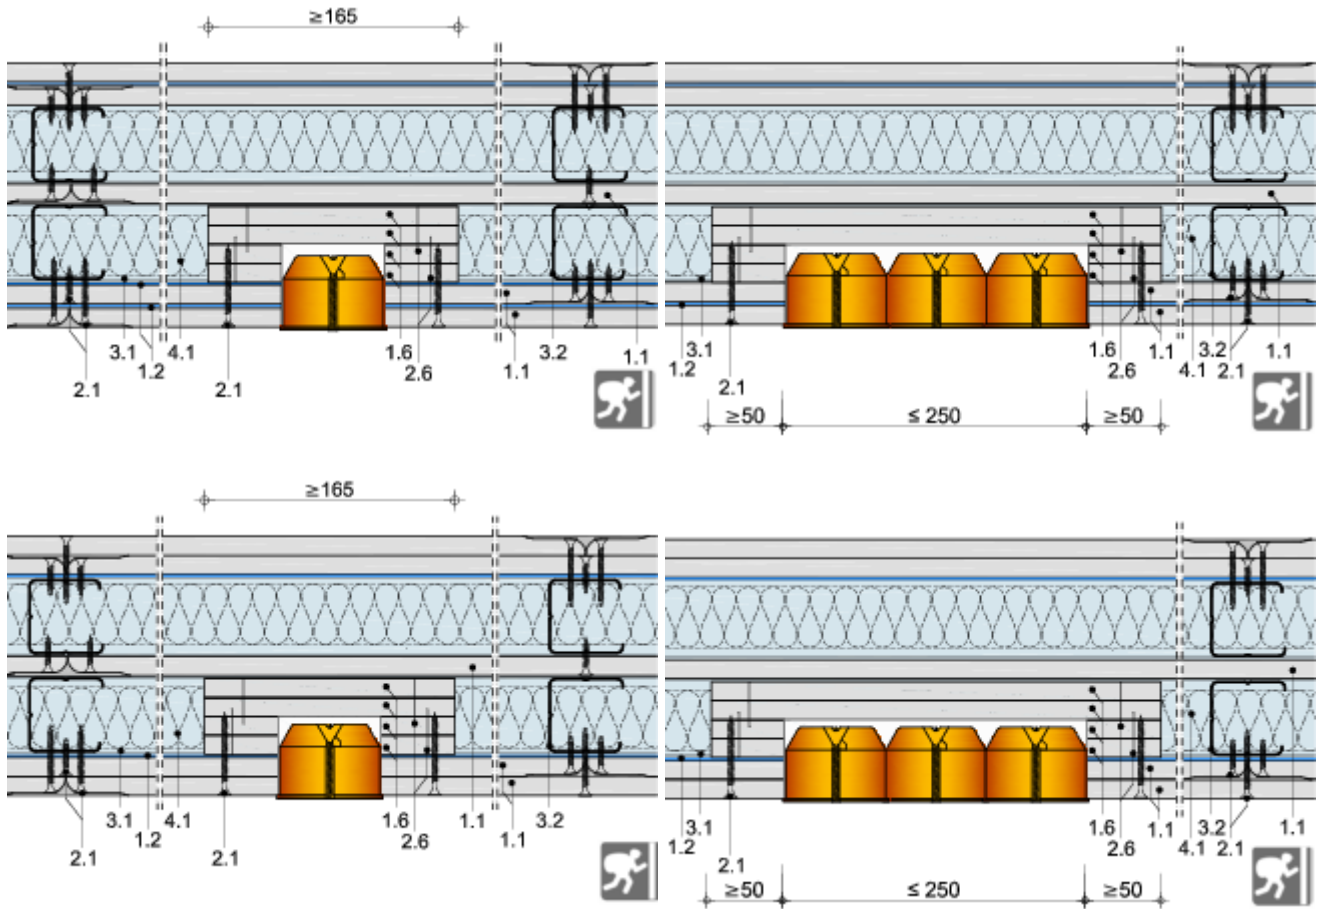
Steckdoseneinbau Einfachständerwand RC 2
